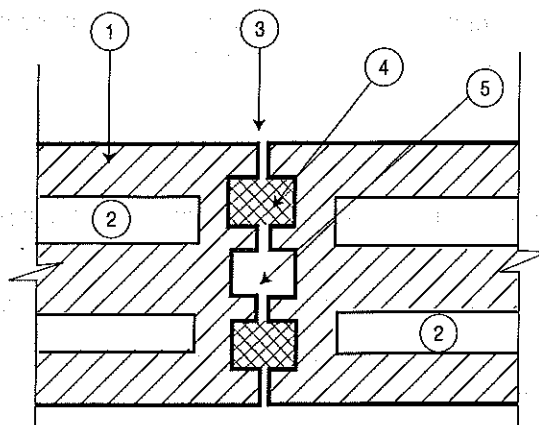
Coupe horizontale sur mur en blocs béton.
